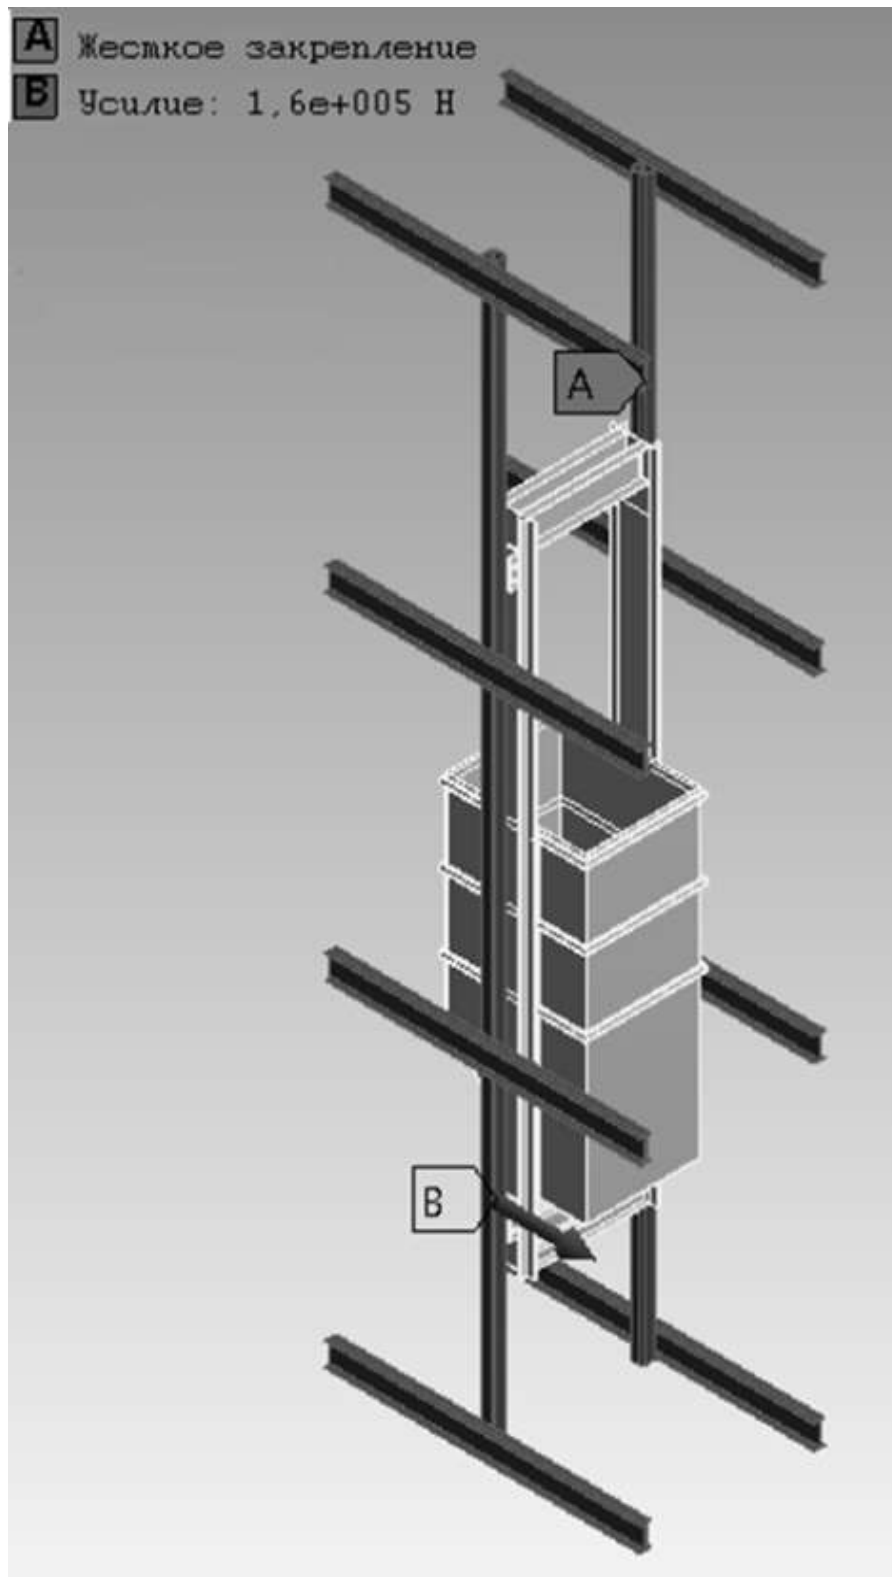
Расчетная схема по определению минимальной величины перекрытия проводника башмаком
